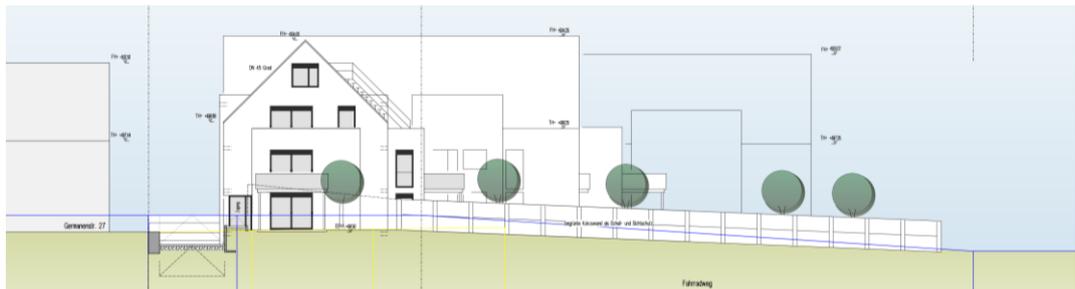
Neubau von 12+9+3+6 WE mit Tiefgarage und Stellplätzen, Alemannenstraße 30, Holzgerlingen – Ansicht Nord, Planungsgruppe-S, Urbach, Stand 17.12.2021
